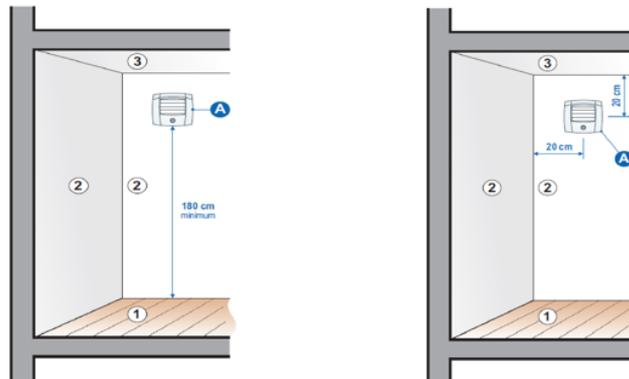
positionnement des bouches d'extraction (CEREMA)
